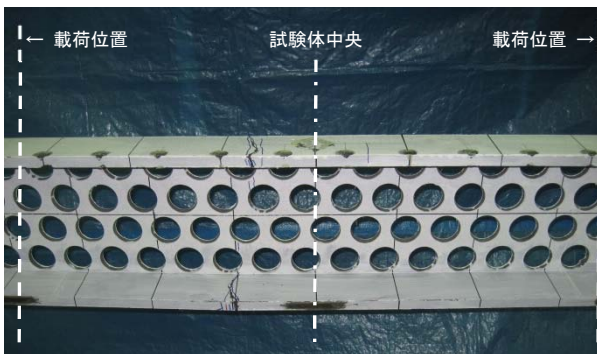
載荷実験におけるひび割れ状況 (A 方向載荷)
